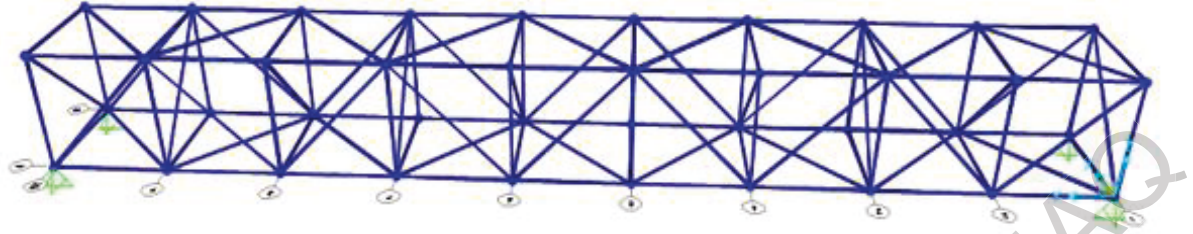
Estructura tipo truss estudiada en la investigación.
